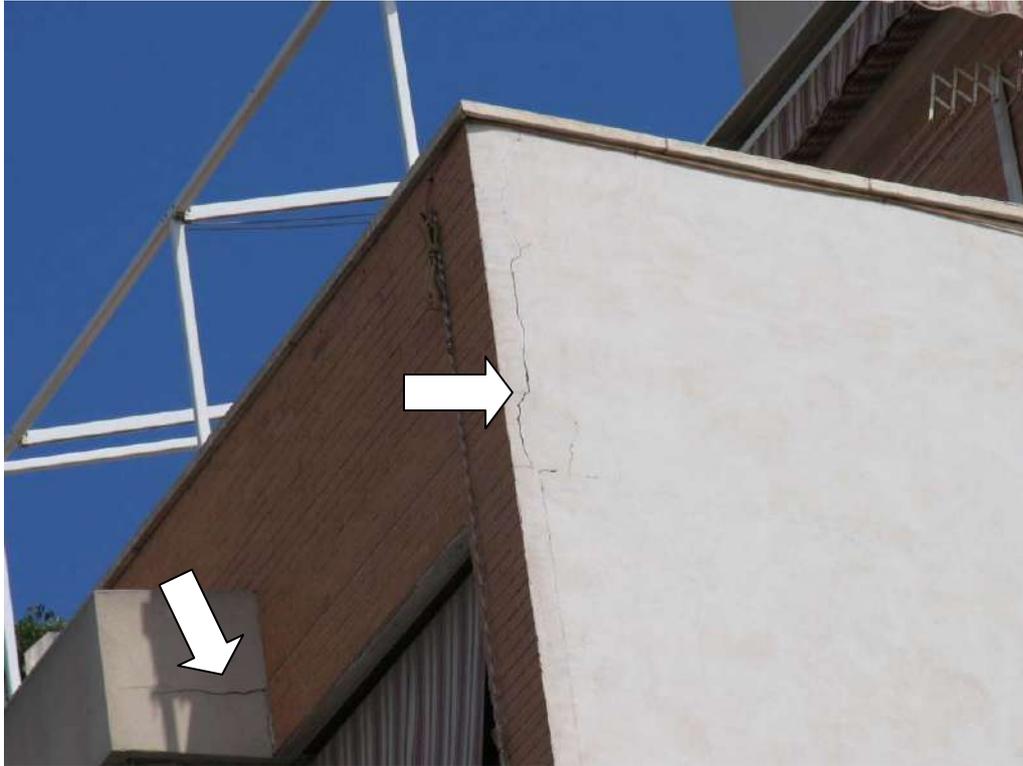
Detalle de fisura vertical entre la pared medianera y la fachada y de otra fisura horizontal en el voladizo
